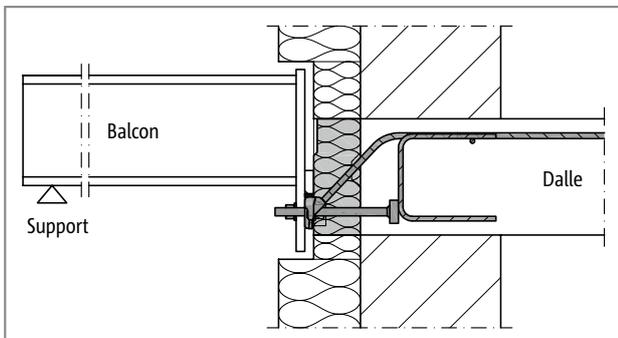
Schöck Isokorb® T type SQ : Transition sans obstacle grâce au décalage en hauteur
